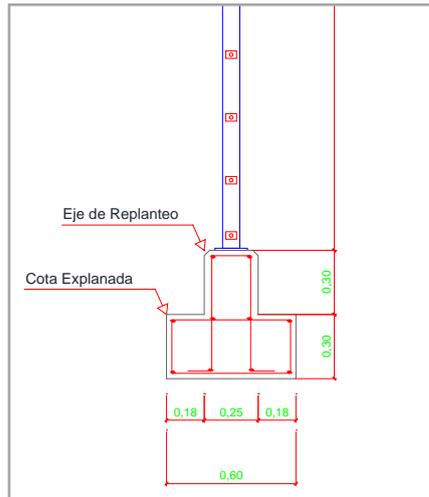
detalle de la armadura del muro y del eje en planta para el replanteo.
